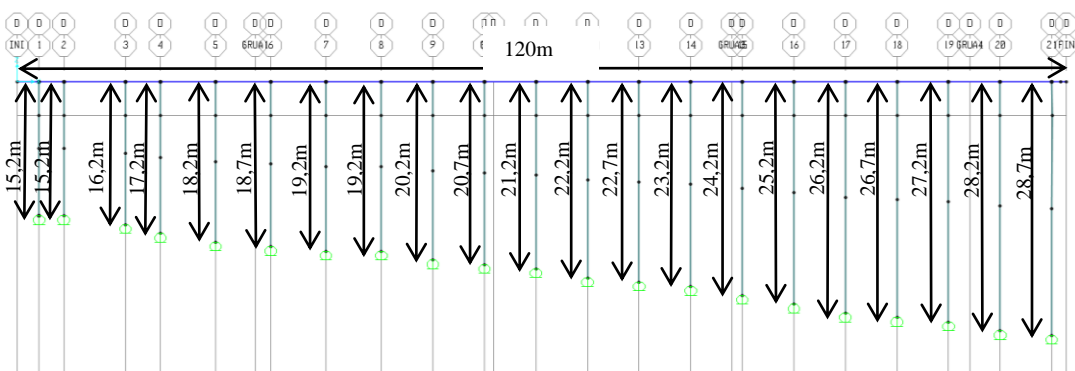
Vista en elevación del plano D de geometría, paralelo a plano X-Vertical'.
